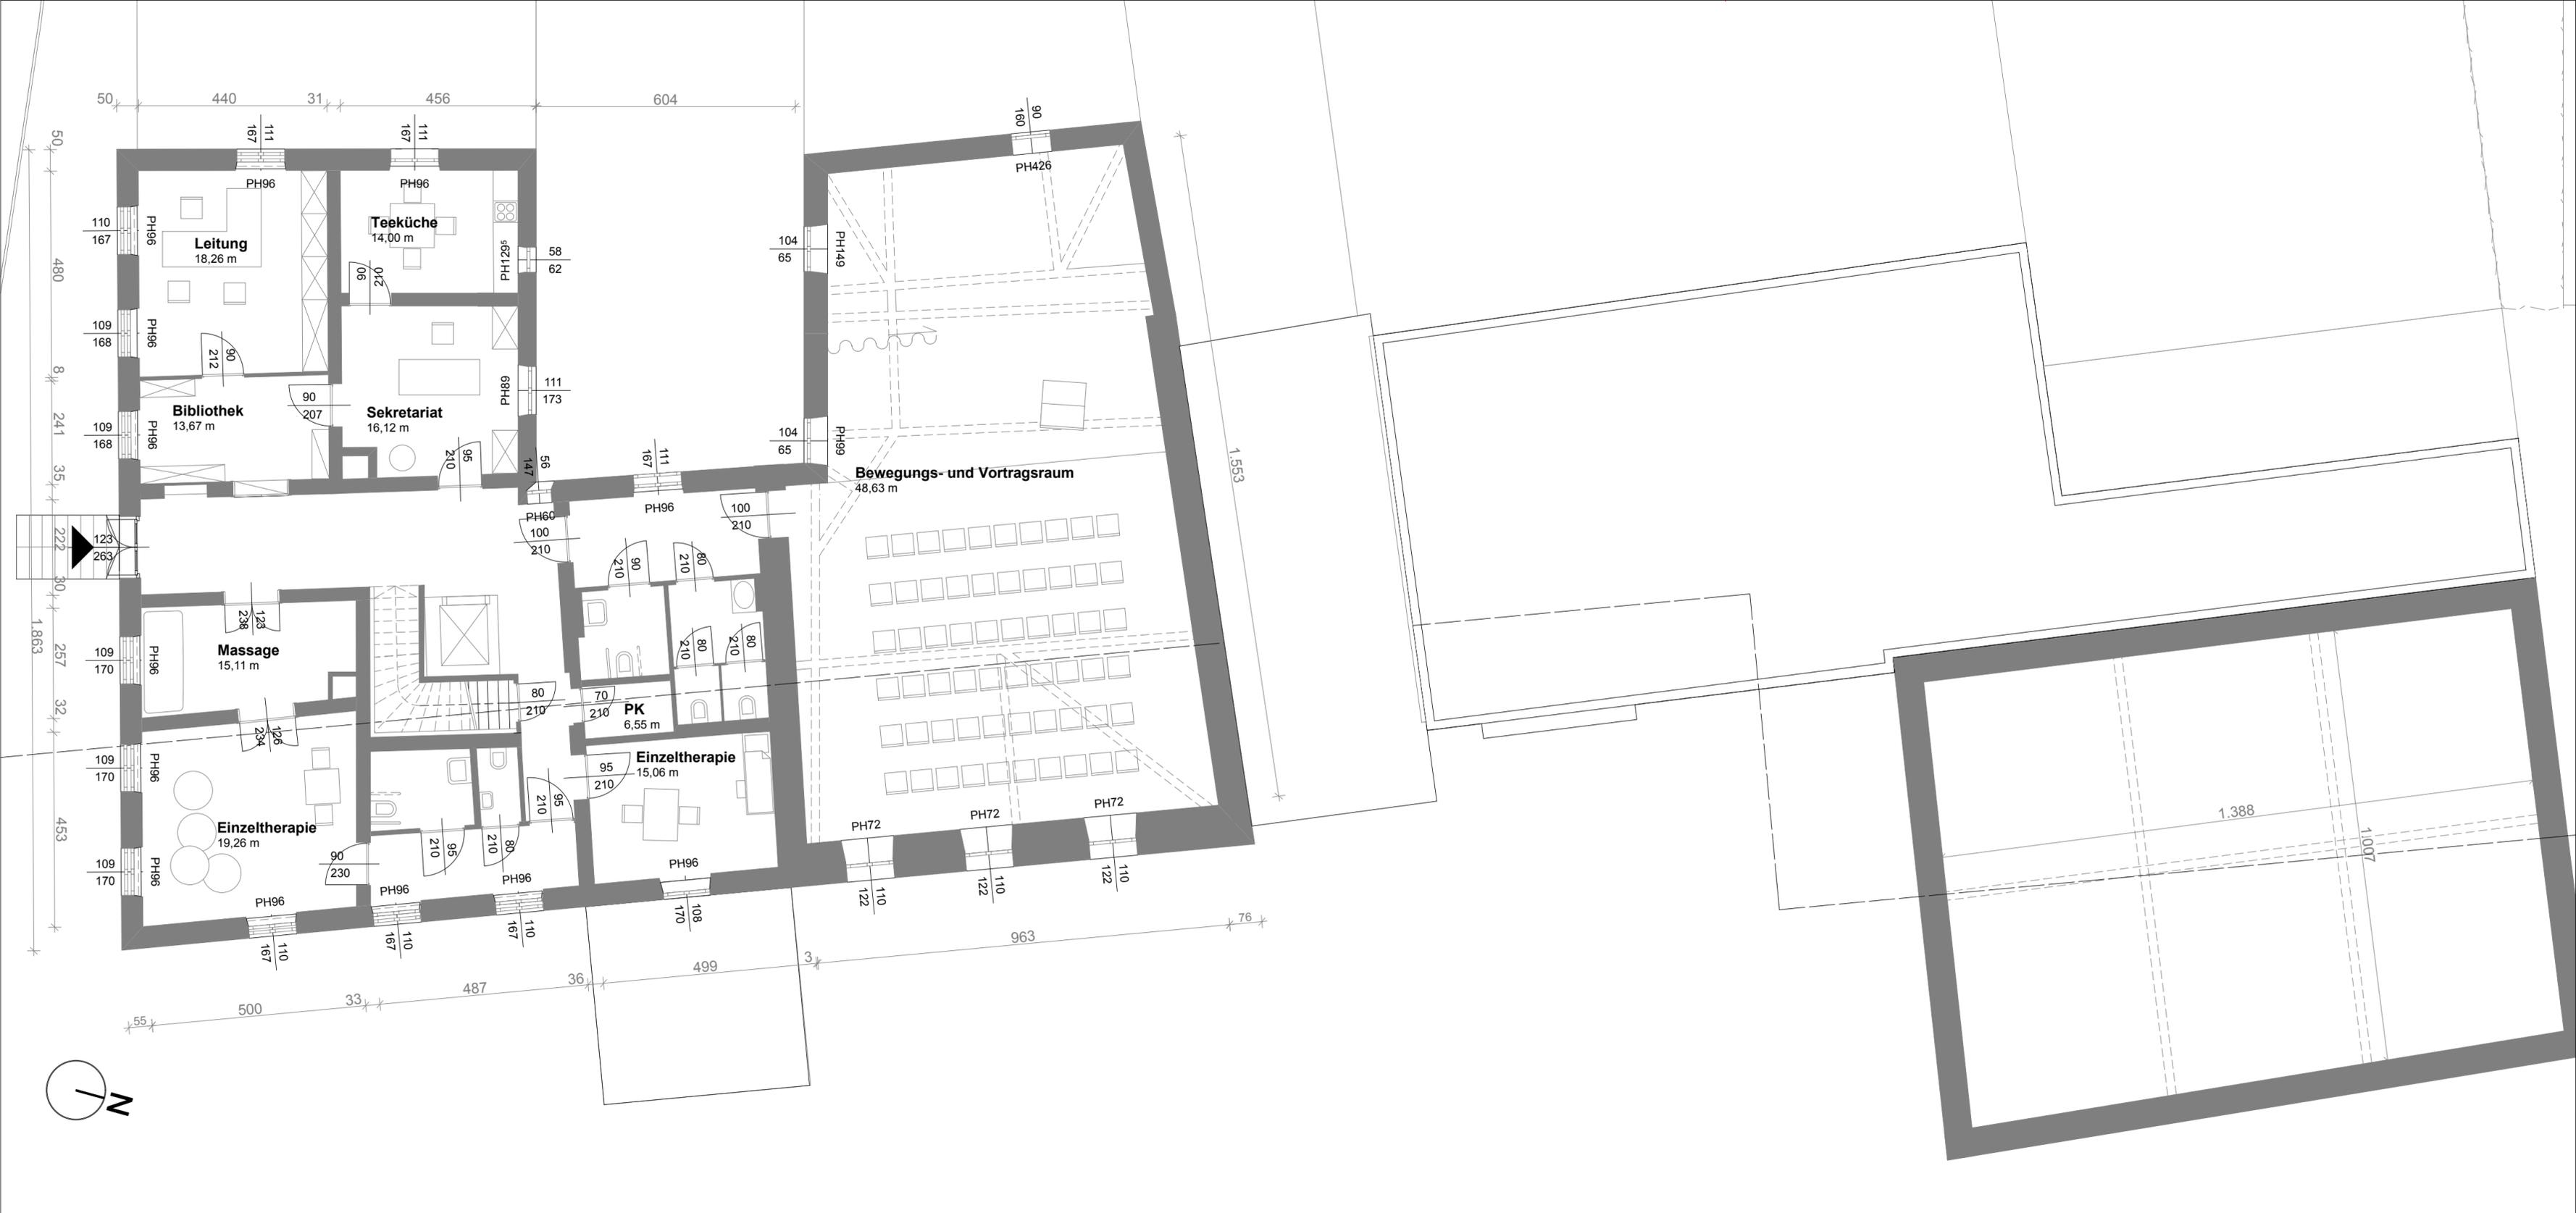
Abbruchplan Obergeschoß M 1:500
